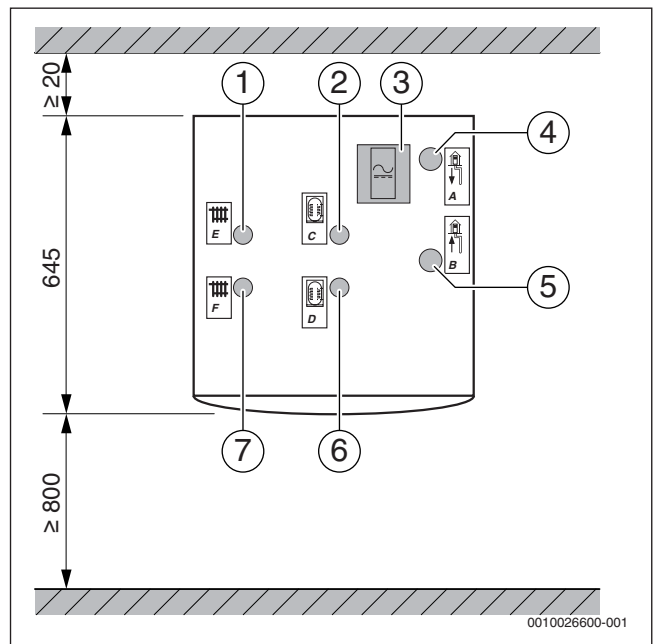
Abmessungen und Mindestabstände WPS 6...8-1 (Draufsicht)
